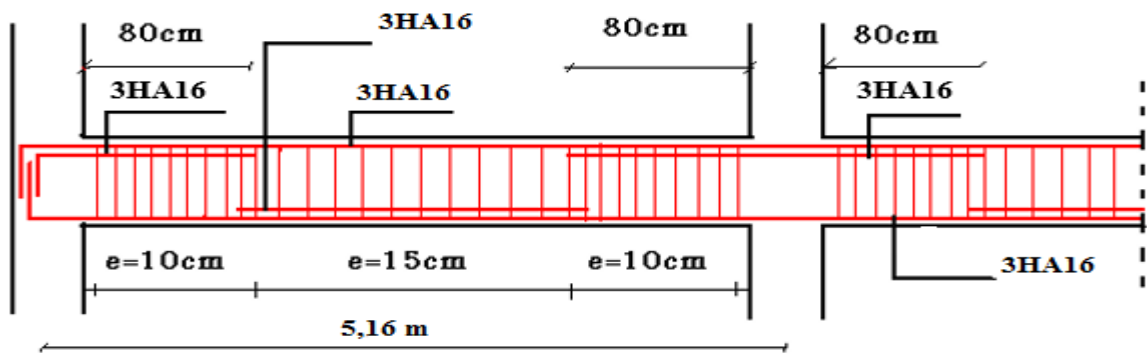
Exemple de dispositions constructives de la poutre principale.
